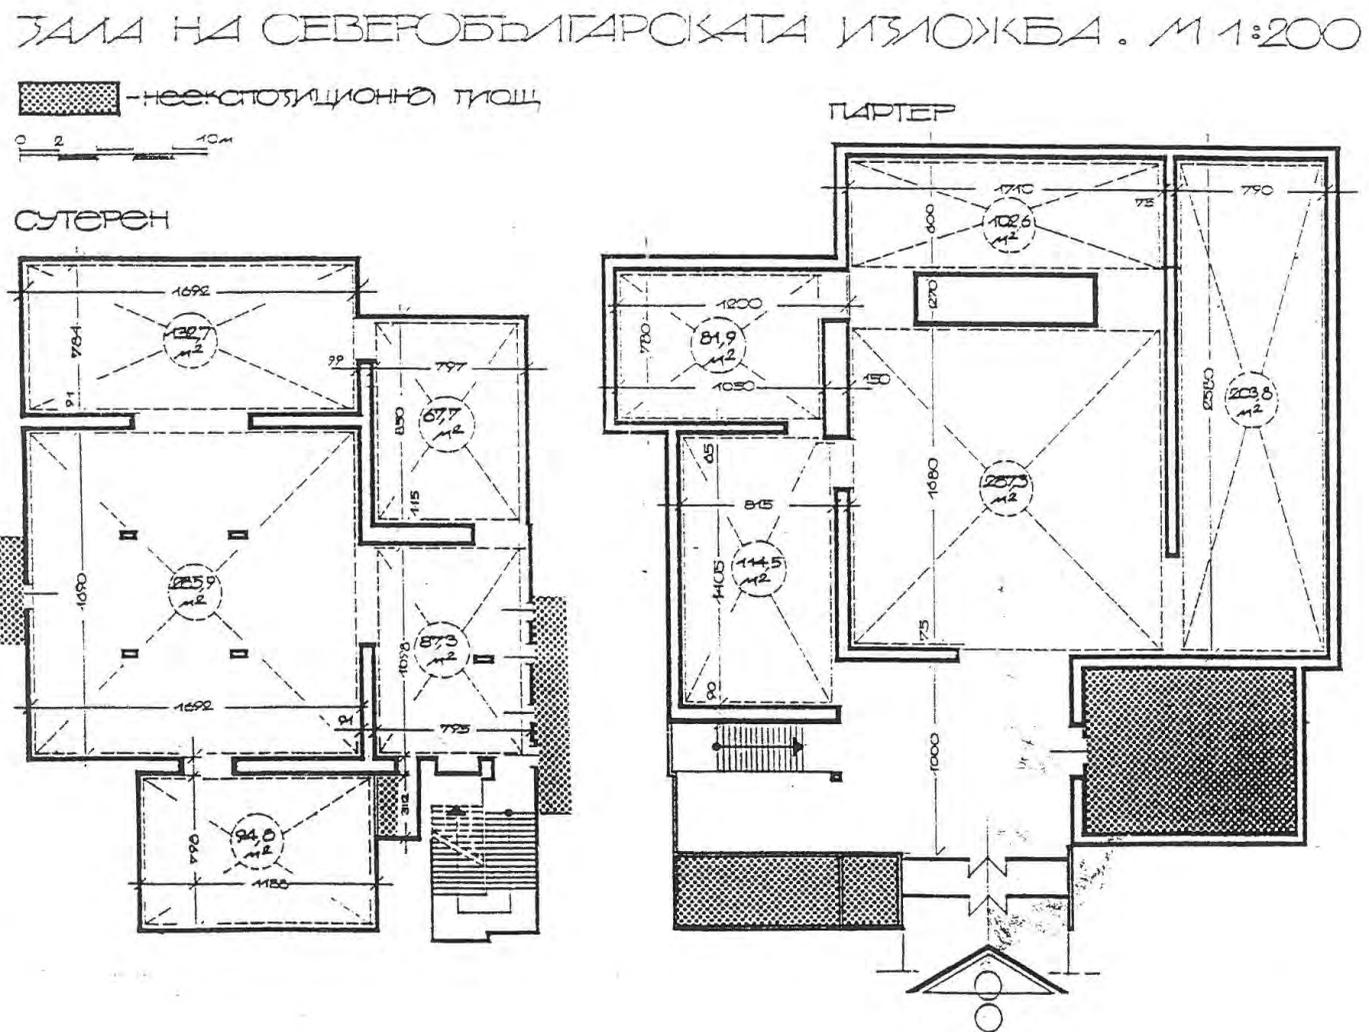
Grundriss Plan – Untergeschoss und Erdgeschoss, Quelle: Kunstgalerie Russe
